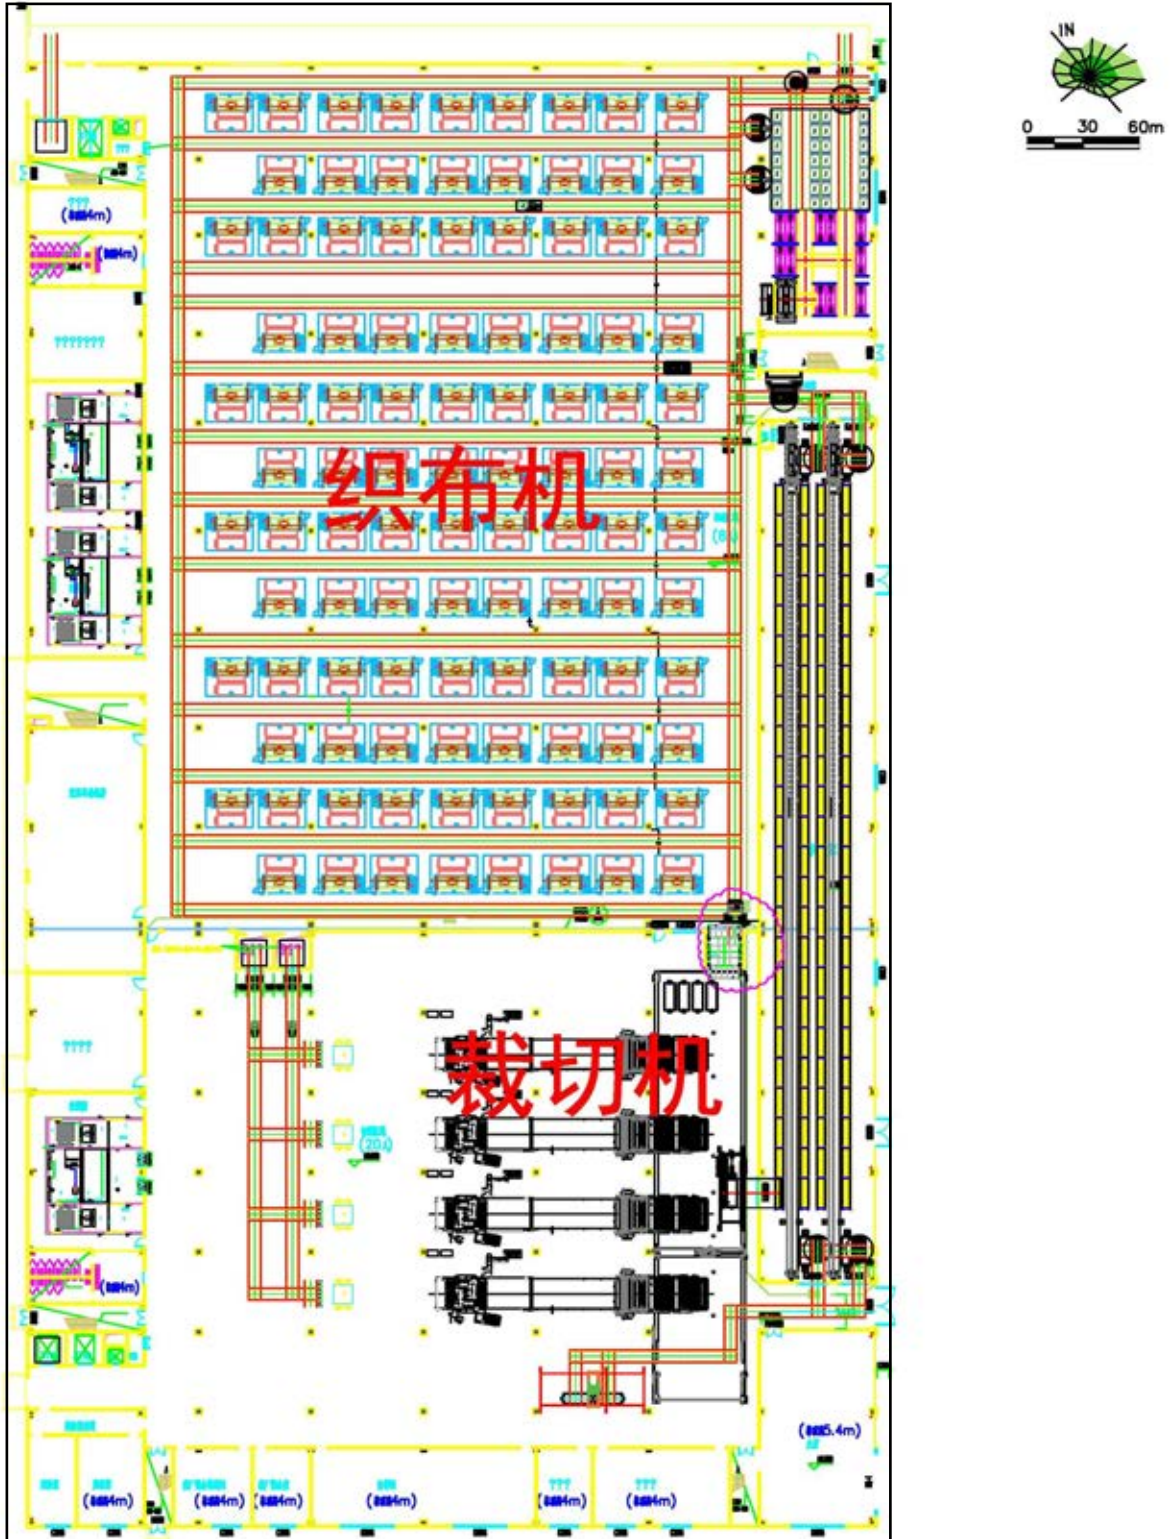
本项目生产大楼一层生产车间平面布置图
